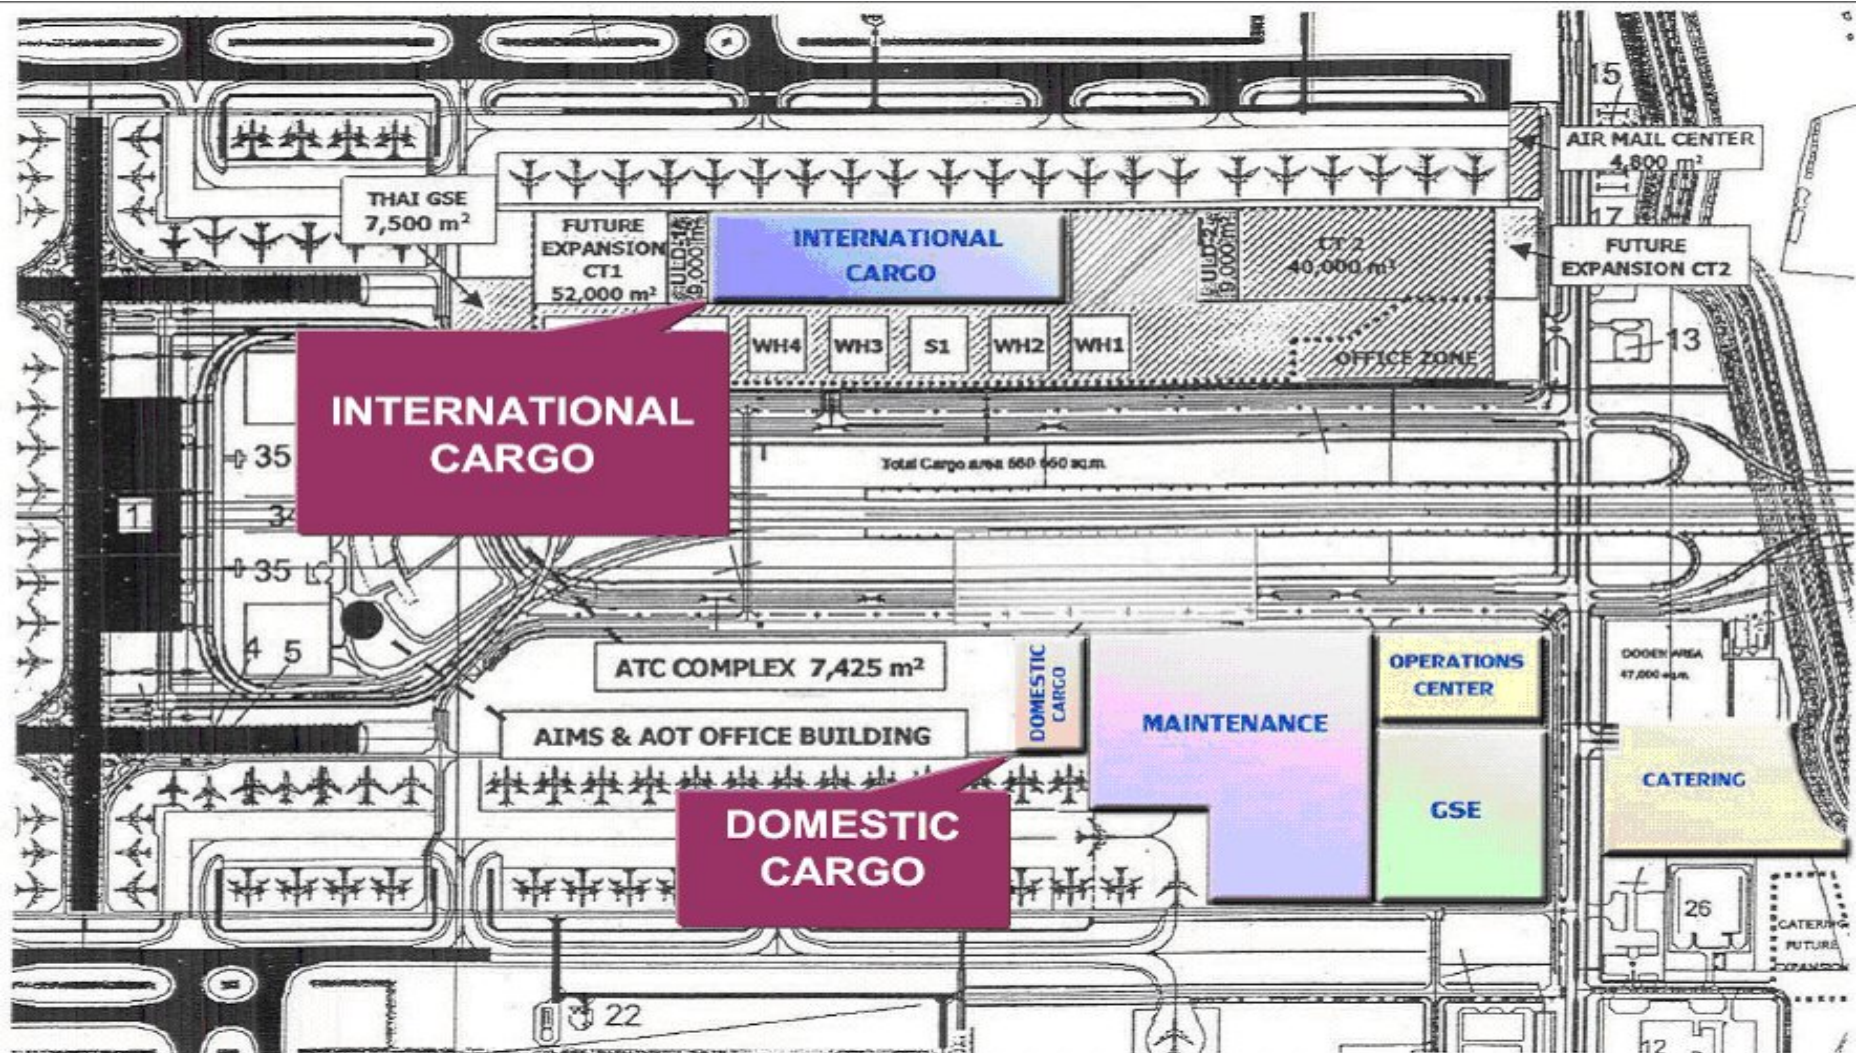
65. Layout del Aeropuerto de Bangkok. Fuente: Web
